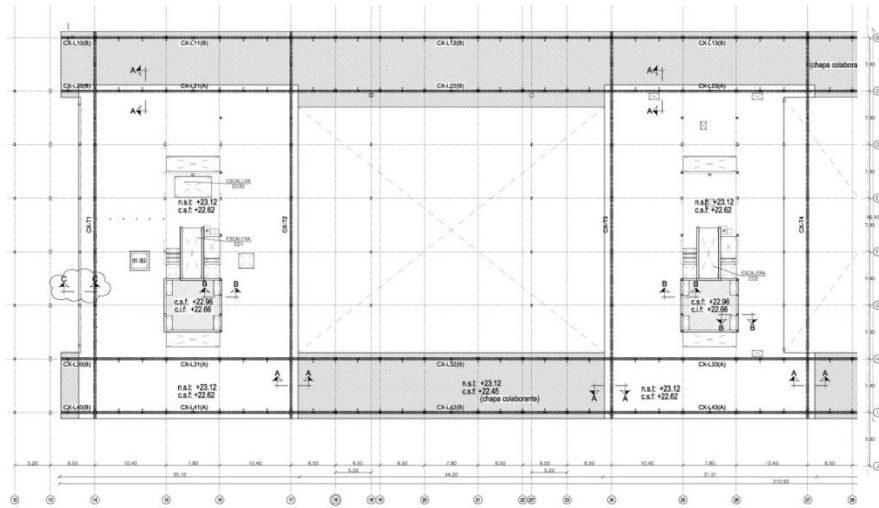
Nivel de planta cubierta (quinta). Mitad oeste. Bloques A y B.
